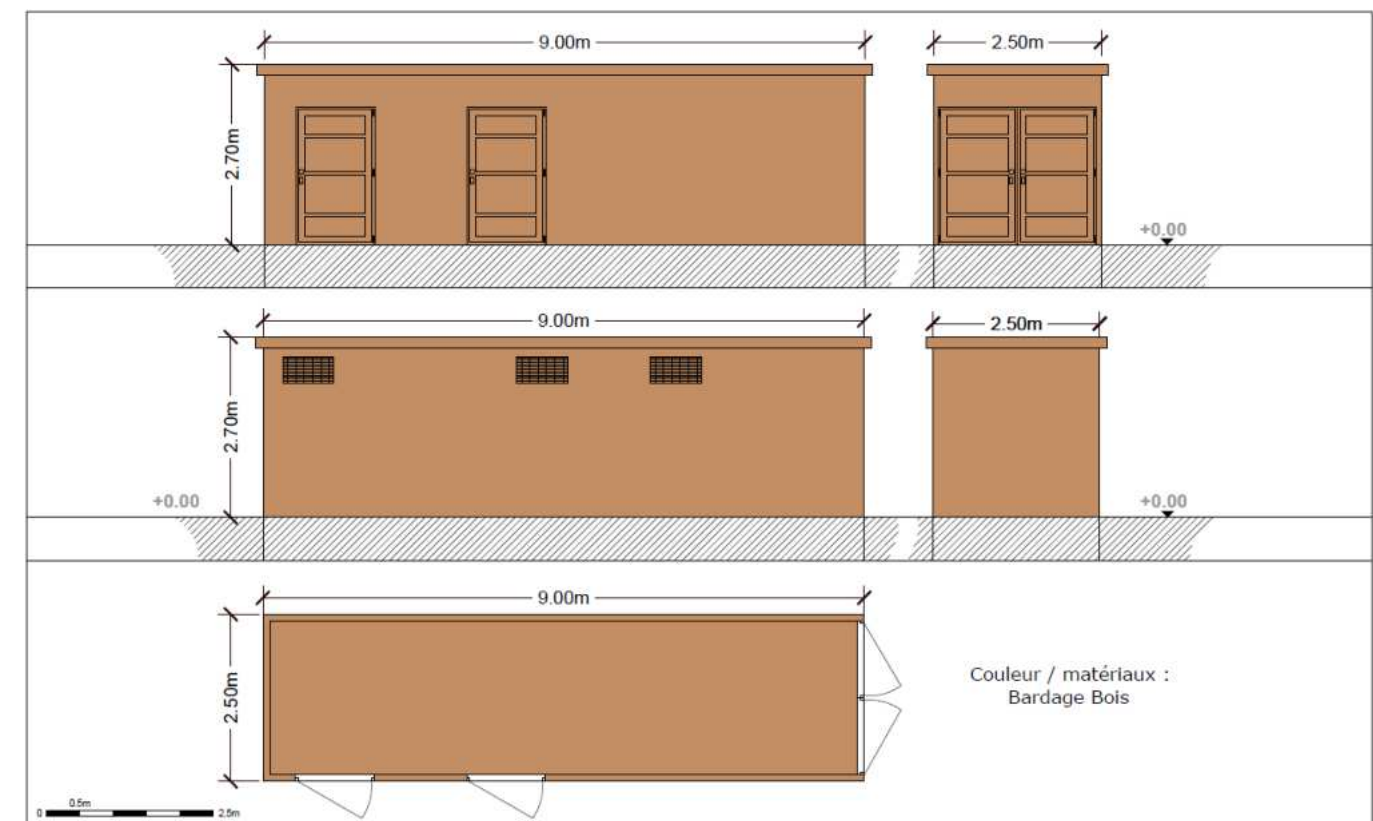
Plan des façades / Plan de coupe du PDL et local technique (Source : SOLVEO)
